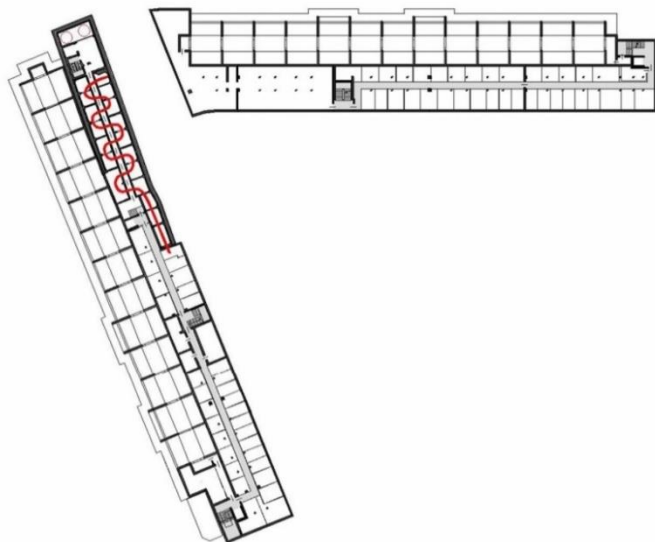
Plano de planta semisótano con localización del sistema de geotermia
